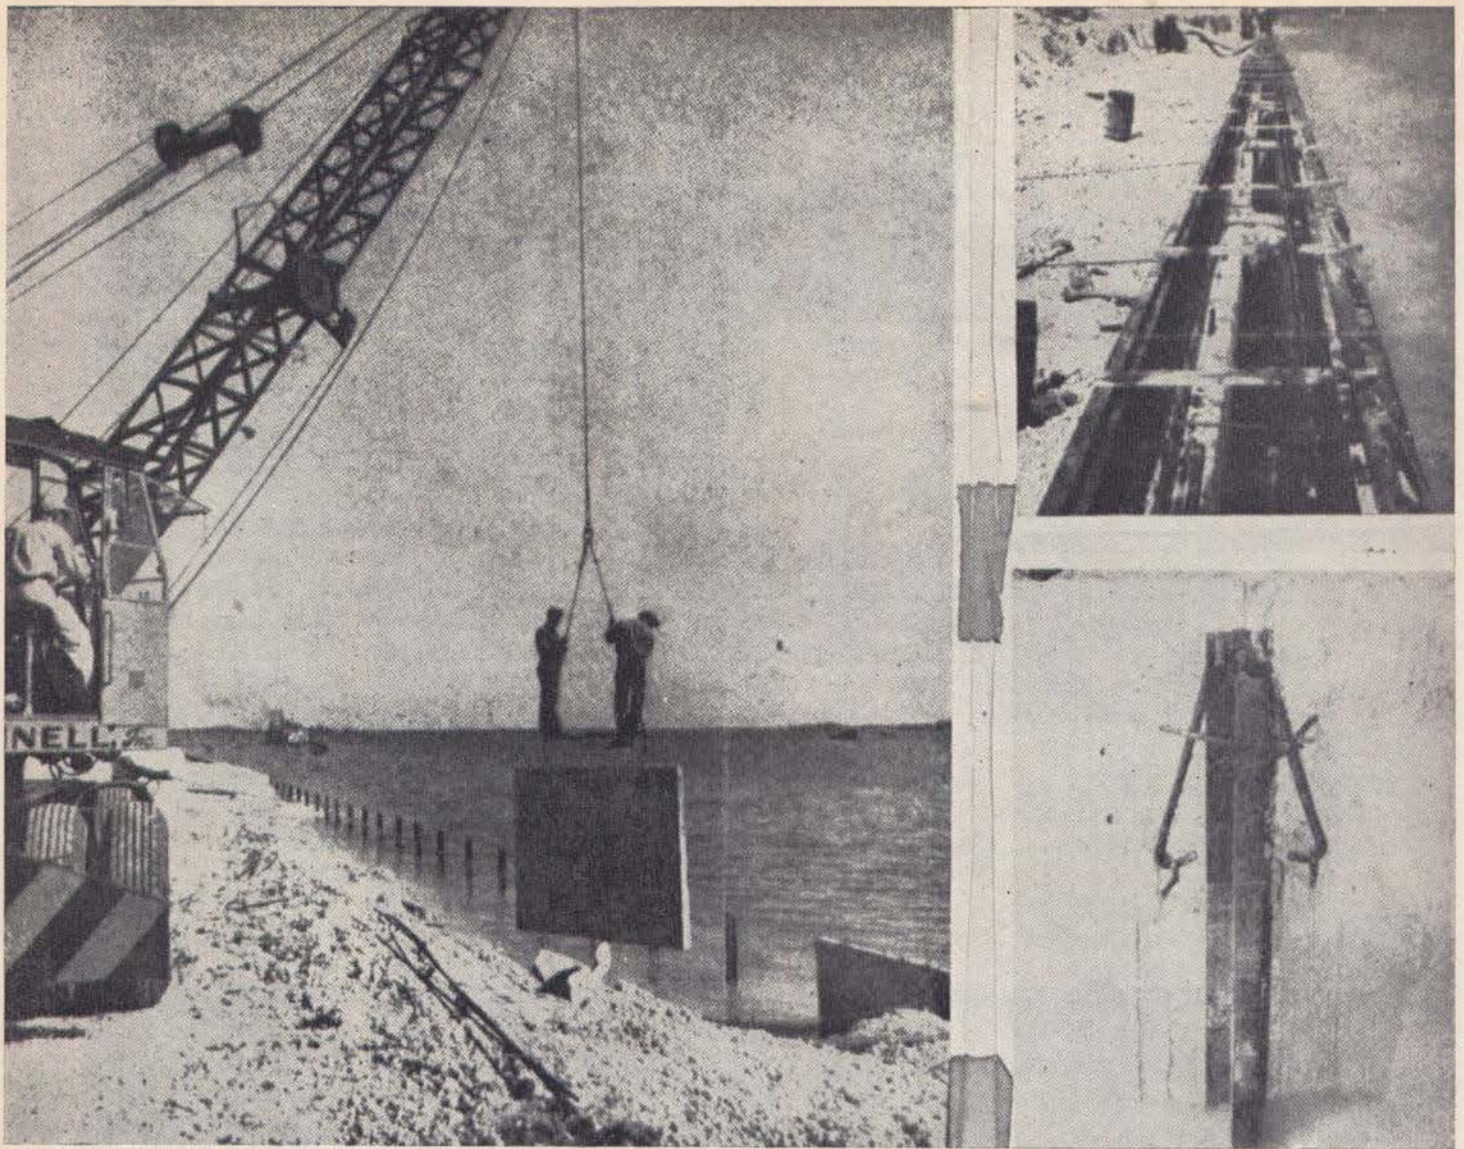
Muro de defensa en Miami, Estados Unidos. a) Colocación de las losas que se apoyan en los pilotes; b) Moldes para el colado del refuerzo de coronación; c) Ganchos y argollas para fijación de las losas a los carriles.
